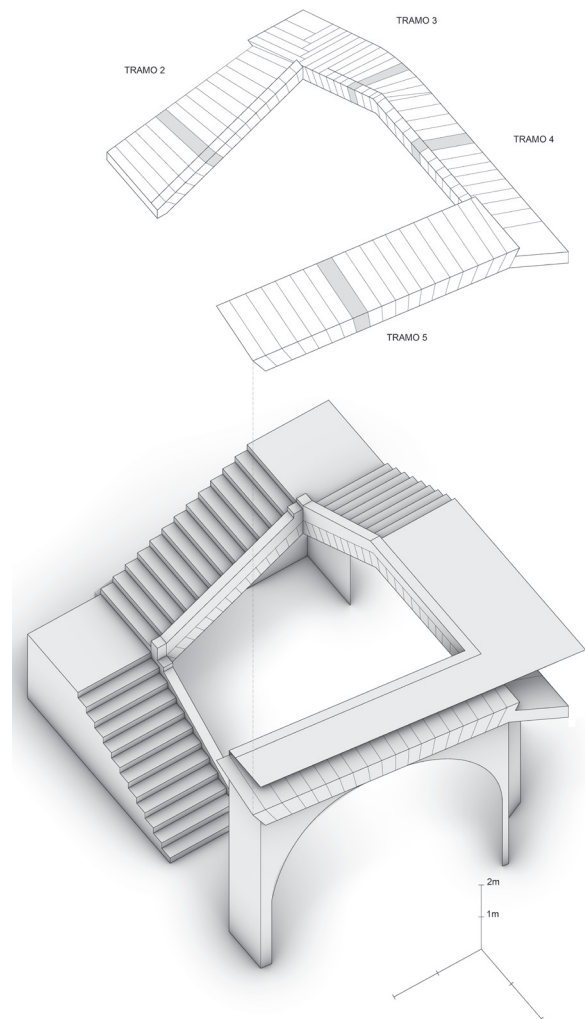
Axonometría superior del conjunto de la escalera (imagen de los autores).
